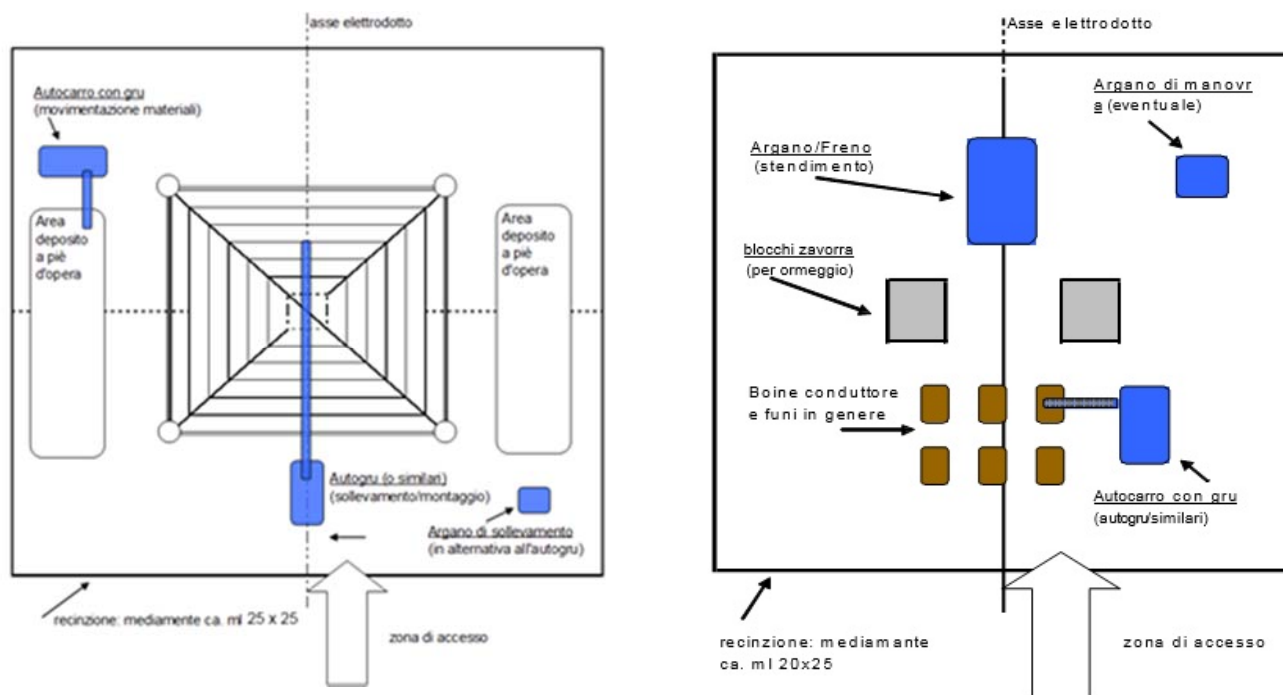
Planimetria dell'Area Sostegno (montaggio sostegno)
